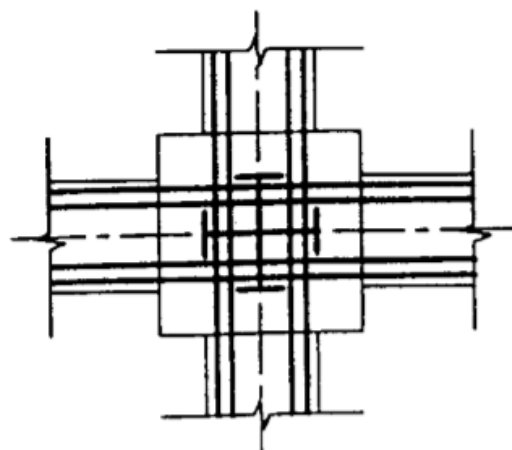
型钢混凝土梁柱节点穿筋构造
